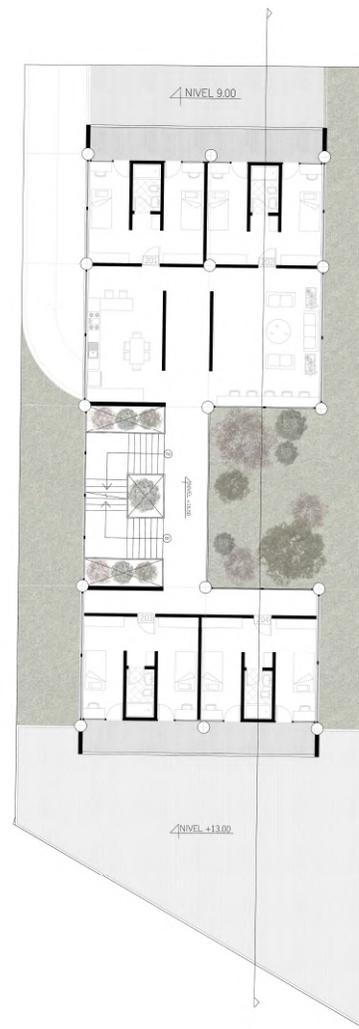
Segunda planta N 16.50 Vivienda becarios. Elaboración Propia
